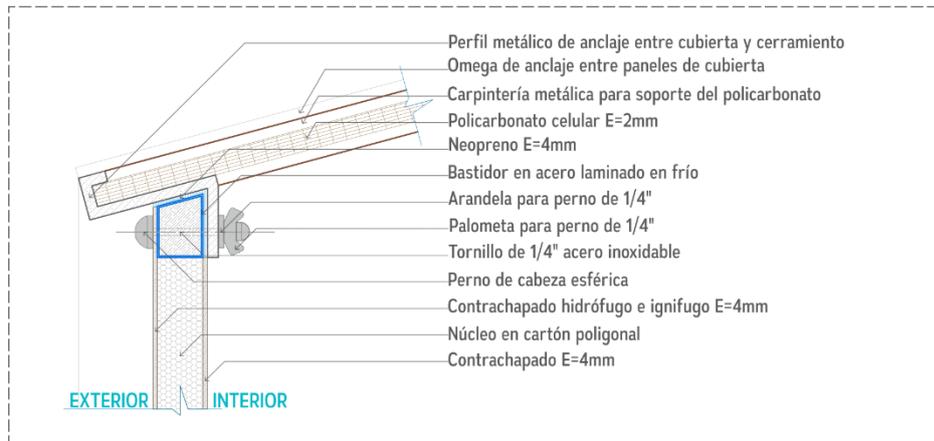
, Detalle en sección de anclaje entre cubierta y cerramiento, fuente: Autor.
